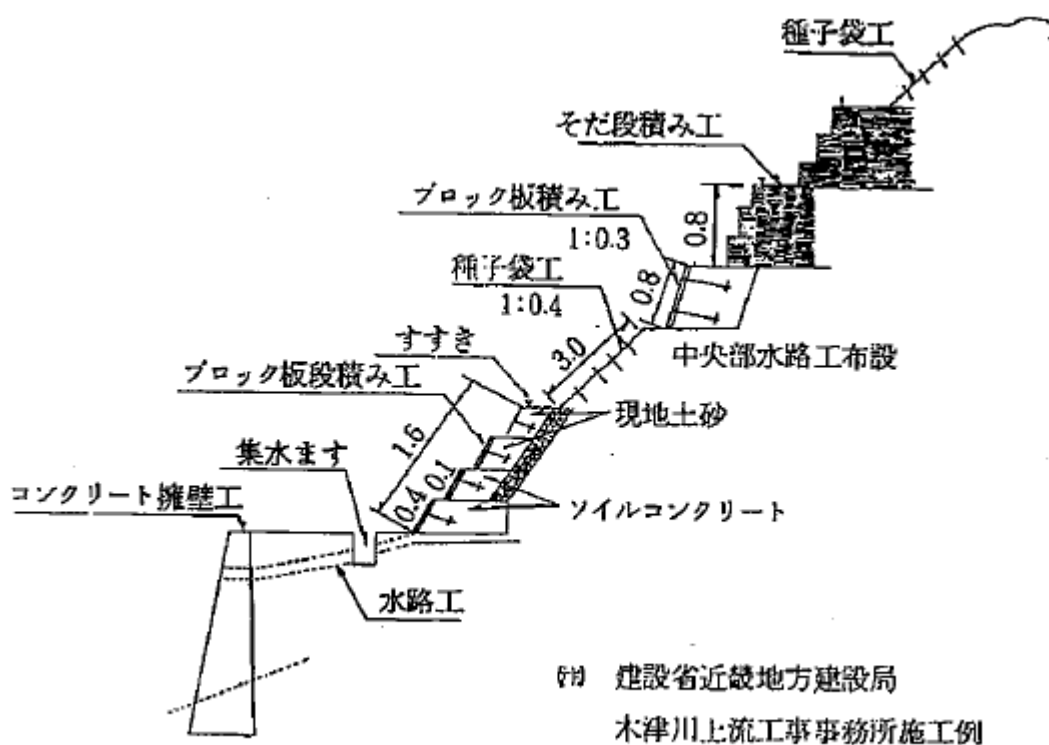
崩壊地（施工例）断面図（単位：m）
